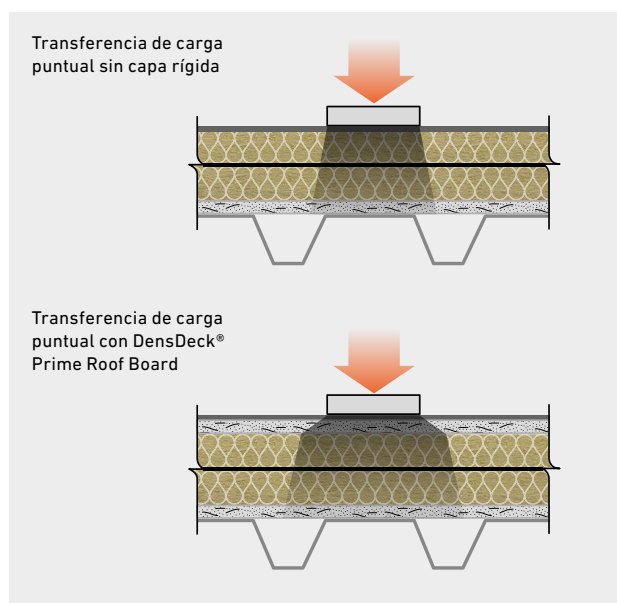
Distribución de carga indicativa: DensDeck® Prime Roof Board ayuda a distribuir las cargas puntuales.
